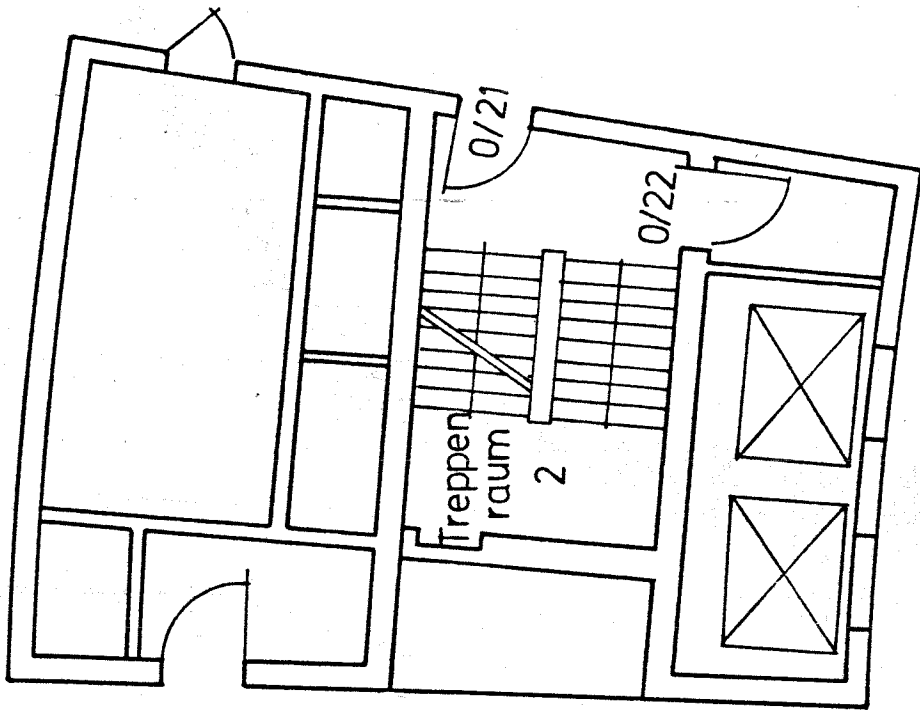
Erdgeschoß, eingebaute Türen und Ausbauzustand beim Brabdiversuch
